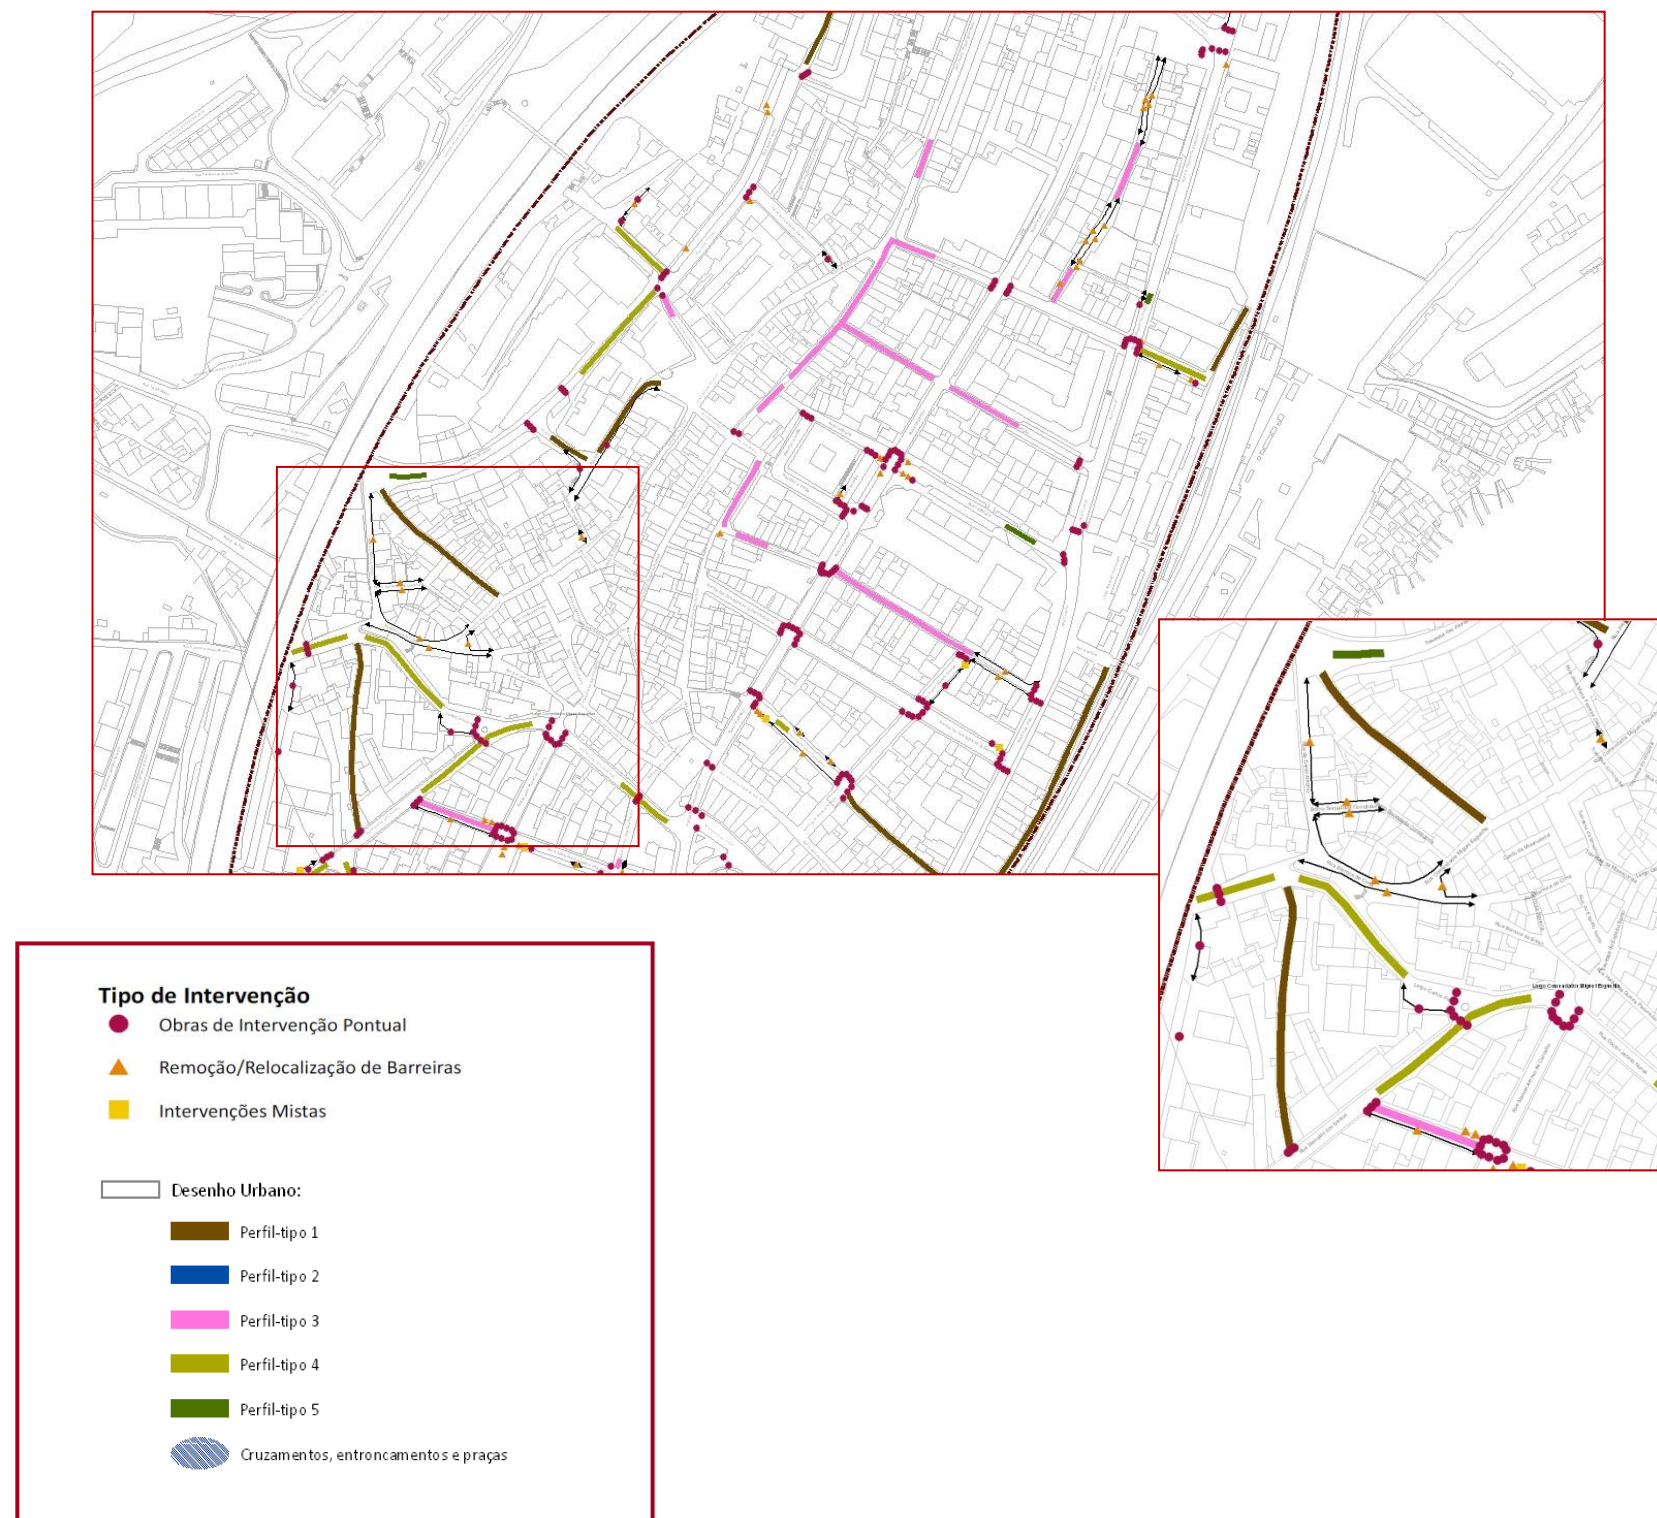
Extracto da Planta de Tipologias de Intervenção (2).
